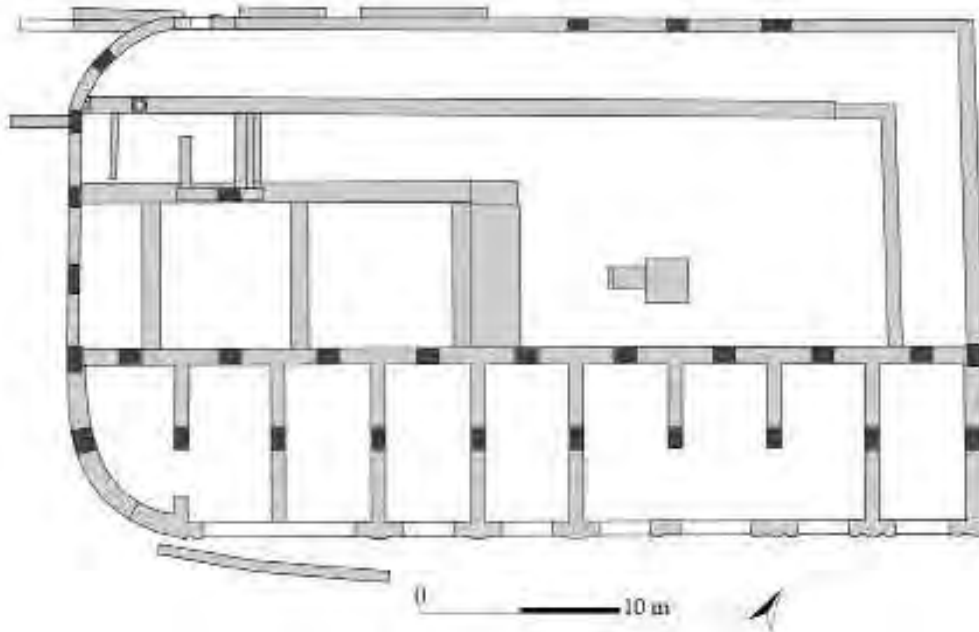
Localizzazione in pianta dei pilastri in blocchi squadrati dell'opera a telaio.
